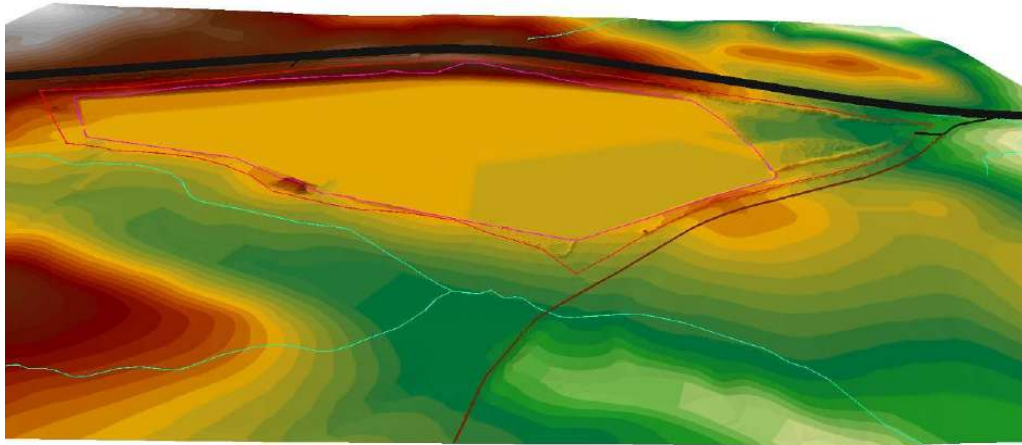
Modelo 3D. Vista S a N. Estado final (restauración).
